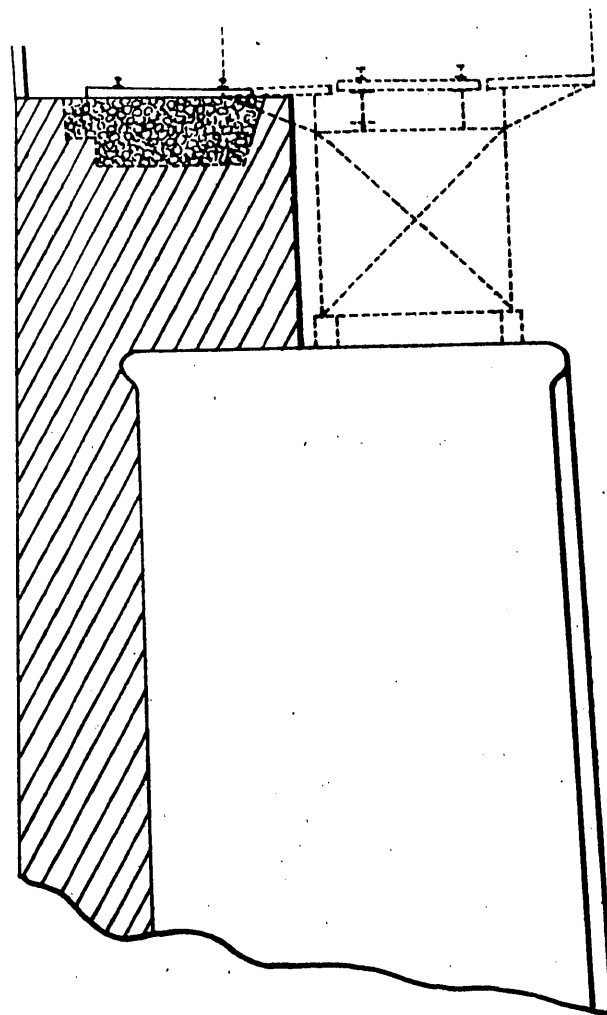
Puente de Tulivana núm. 1. Sección transversal en arranques. Sustitución de un tramo metálico, para vía única, de 30 m. de luz, por un arco de hormigón armado para vía doble.
